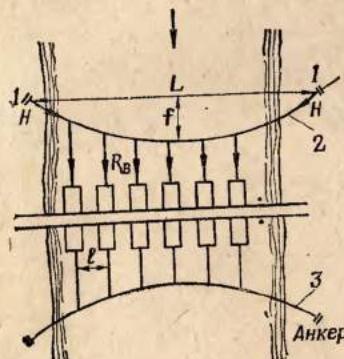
Схема к расчету поперечного закрепления моста при скальных грунтах дна за поперечные тросы:
